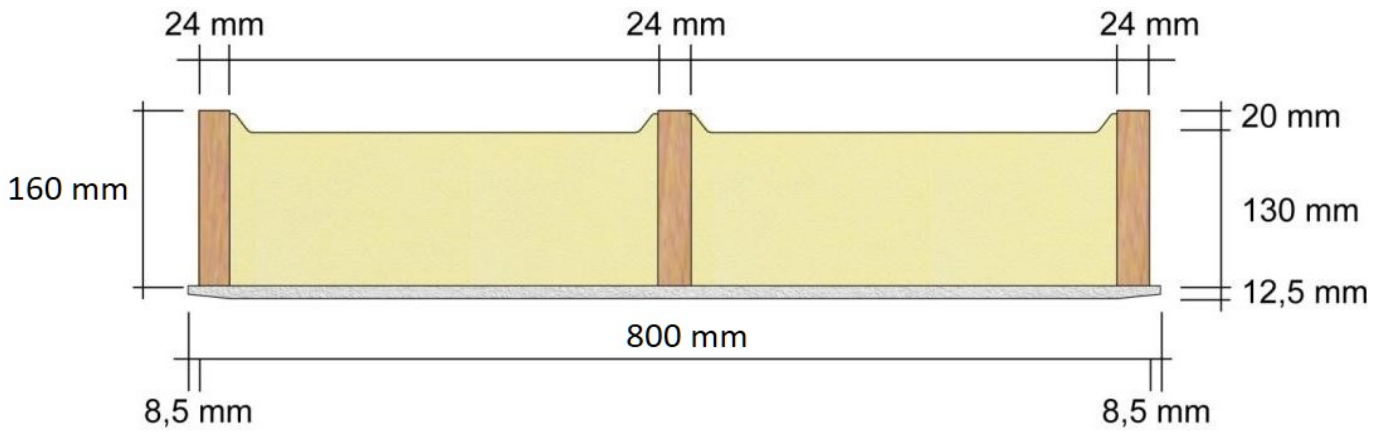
is – Caisson Ussystem Roof OS GYP FRA 130/160
